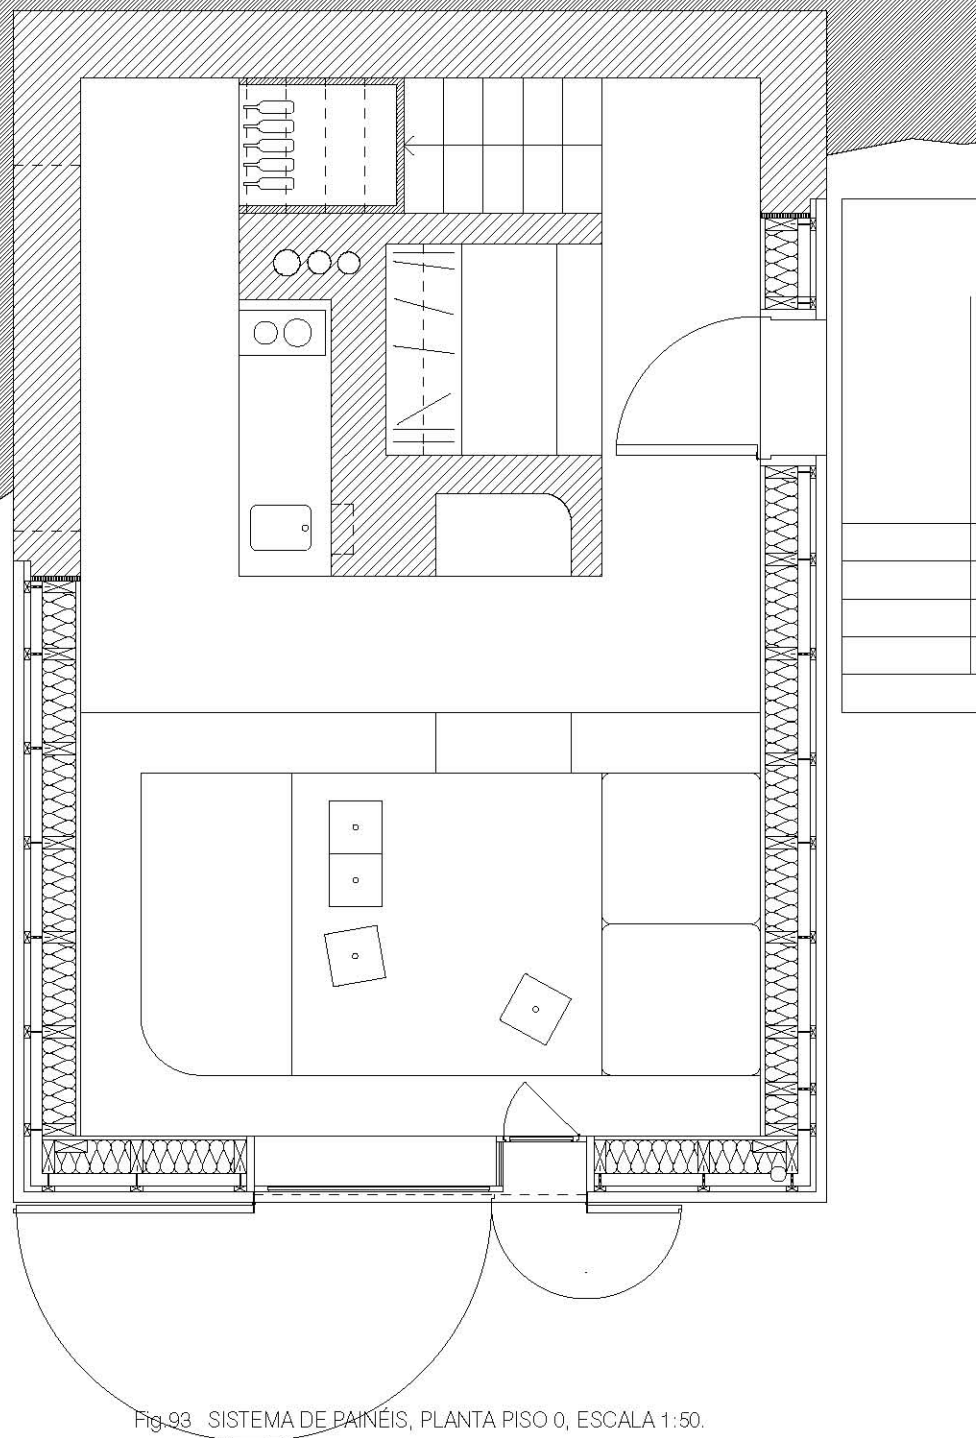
SISTEMA DE PAINÉIS, PLANTA PISO 0, ESCALA 1:50.
